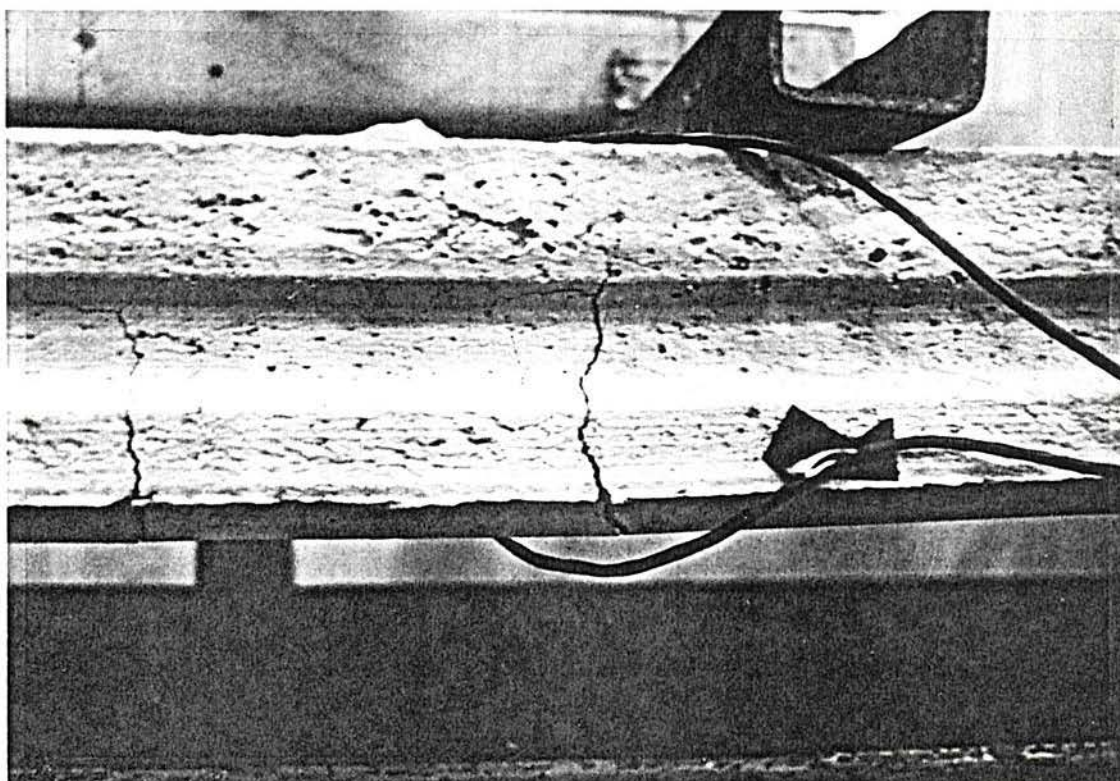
Vista das fissuras provocadas pelo carregamento instantâneo no protótipo B1, região central
